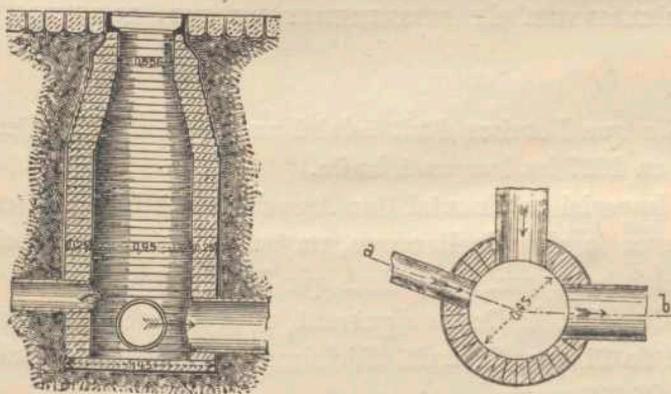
bis. — Coupe et plan d'un regard d'égout.
